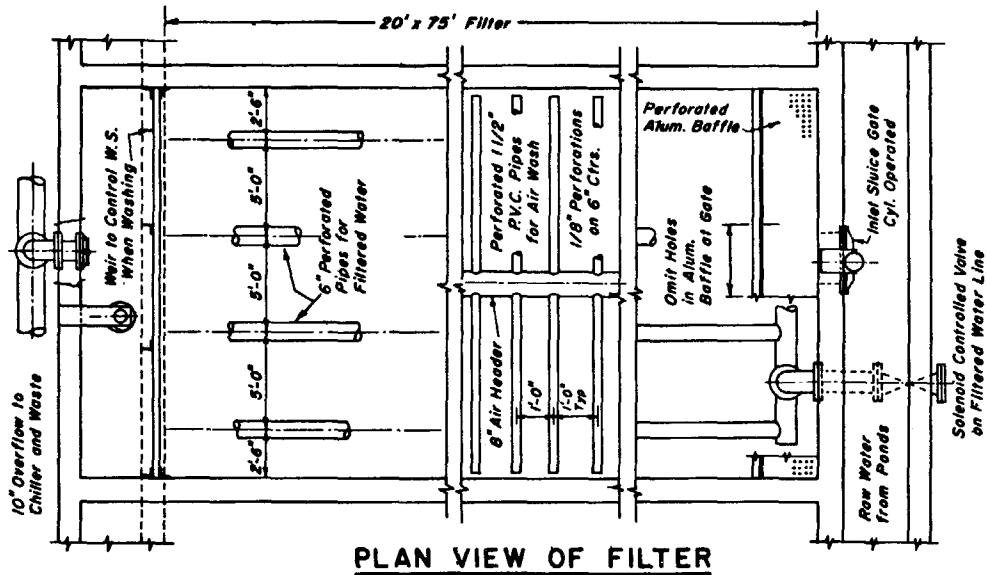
Plans de l'appareil utilisé à Craig Brook et Berlin (New Hampshire)
